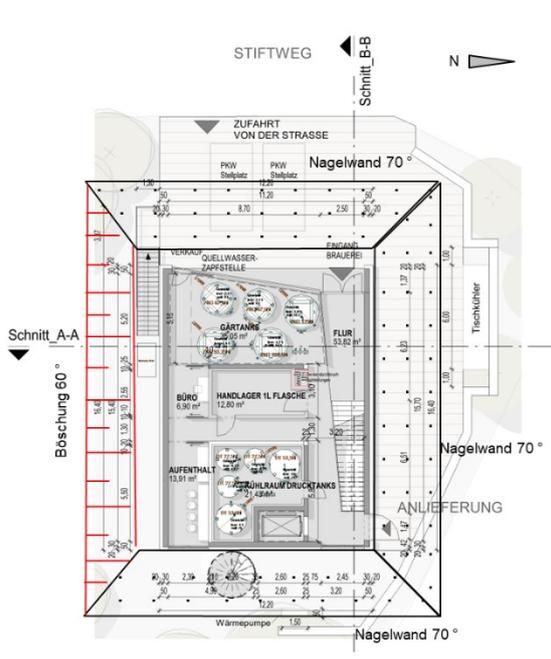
Lageplan Baugrubenempfehlung Brauerei [U 1.3]
